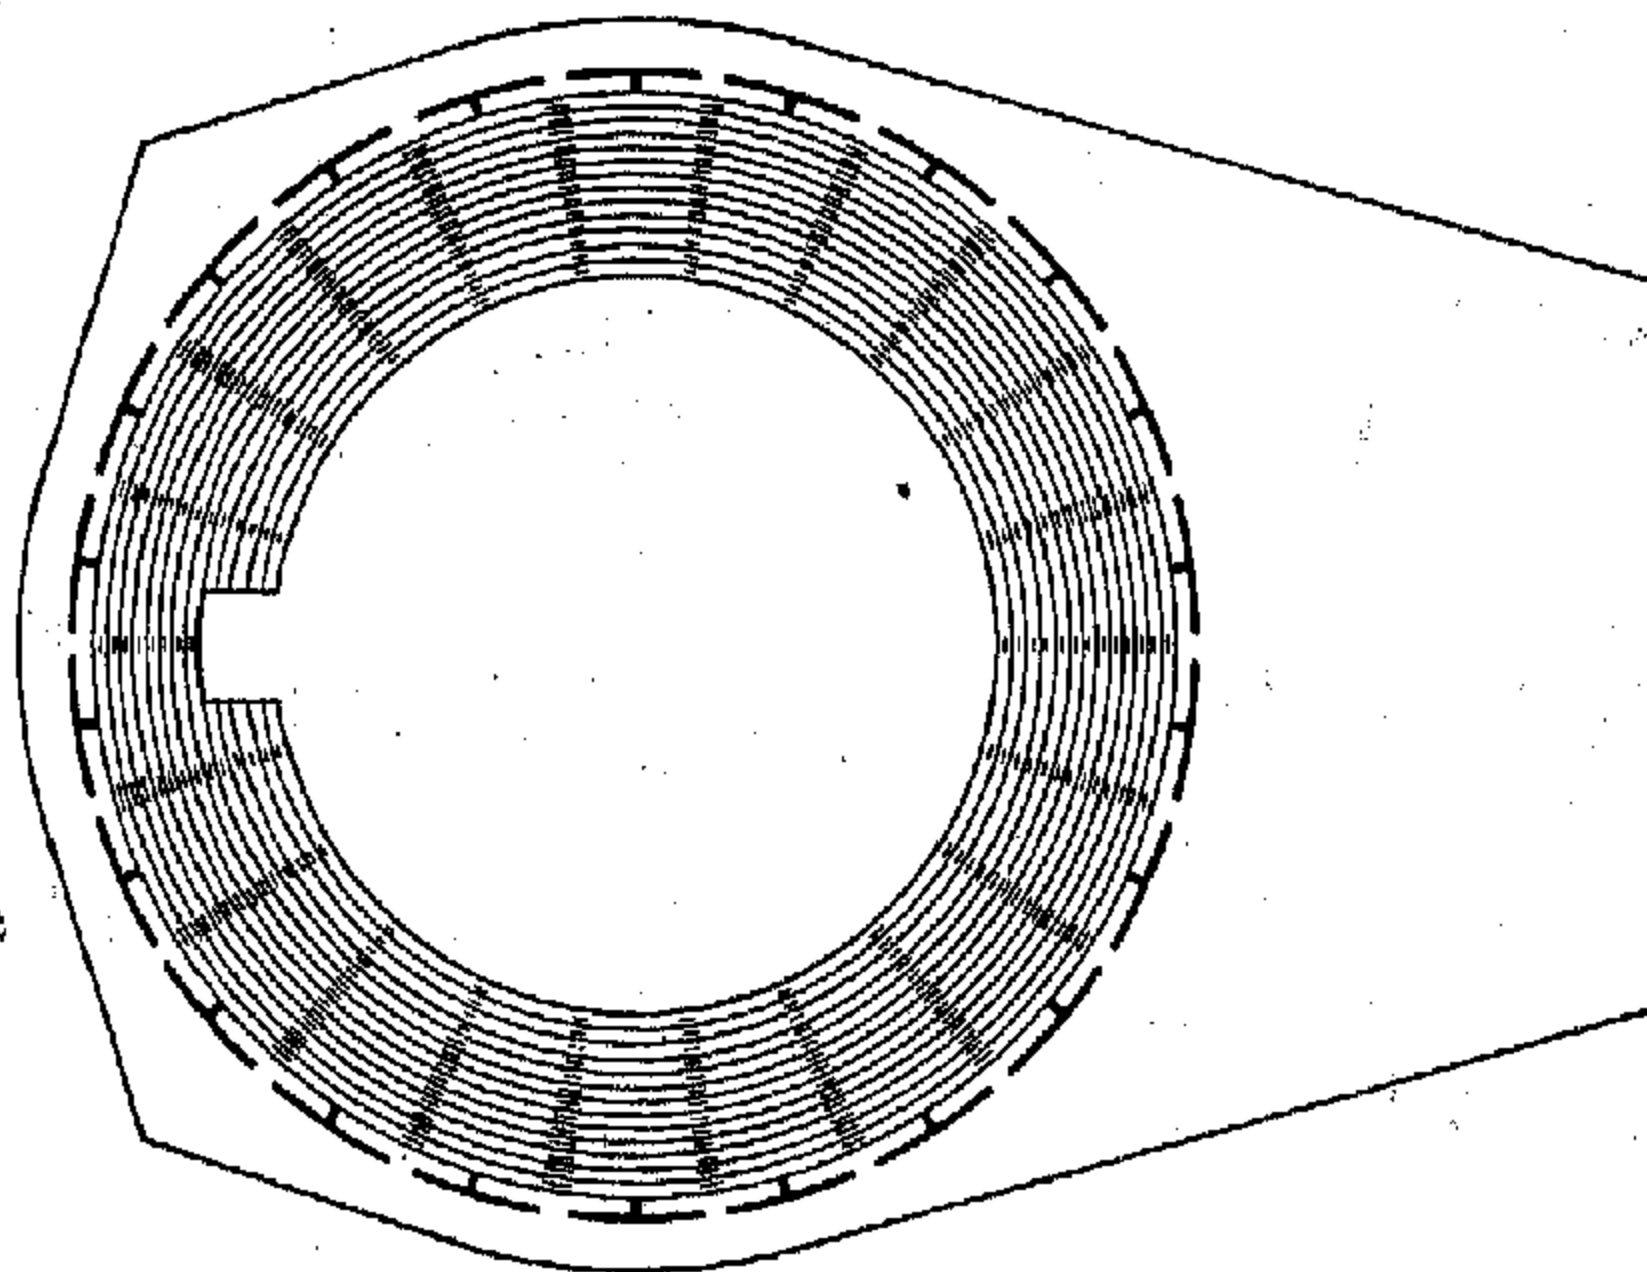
مسقط أفقى للصالة مبينا
